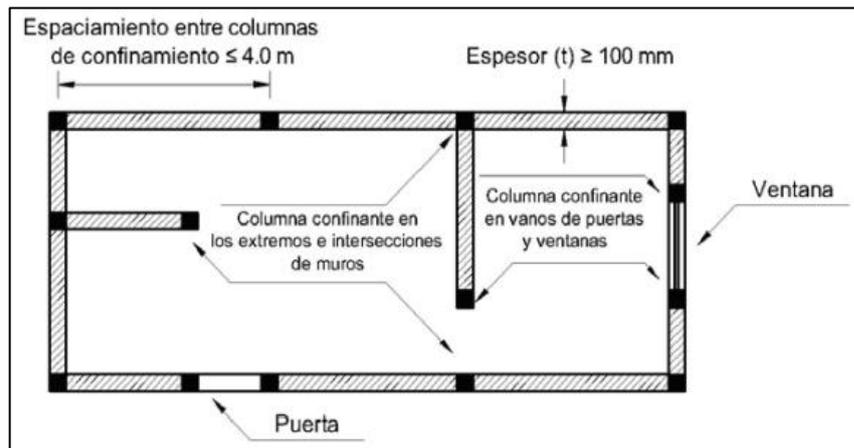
Requisitos fundamentales en viviendas de Mampostería (NEC-SE-VIVIENDA, 2014)
